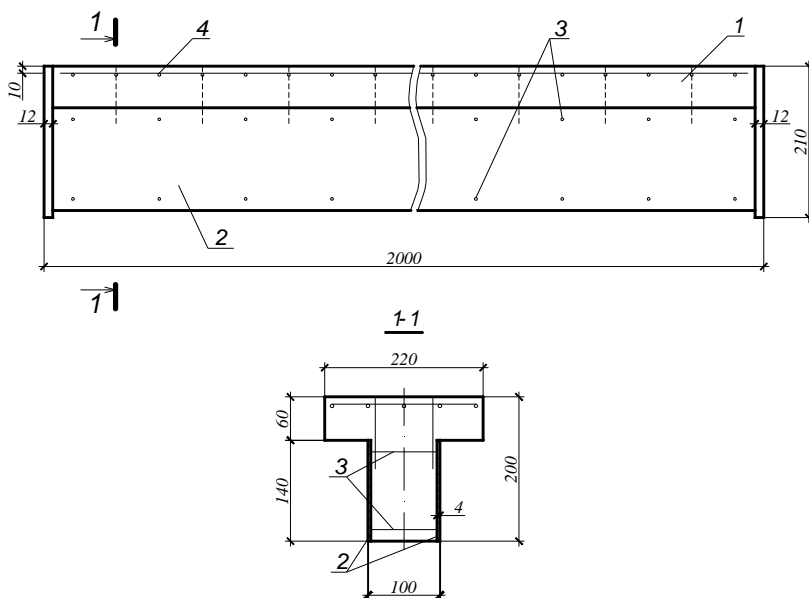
Сталезалізобетонна таврова балка з армуванням вертикальними листами
